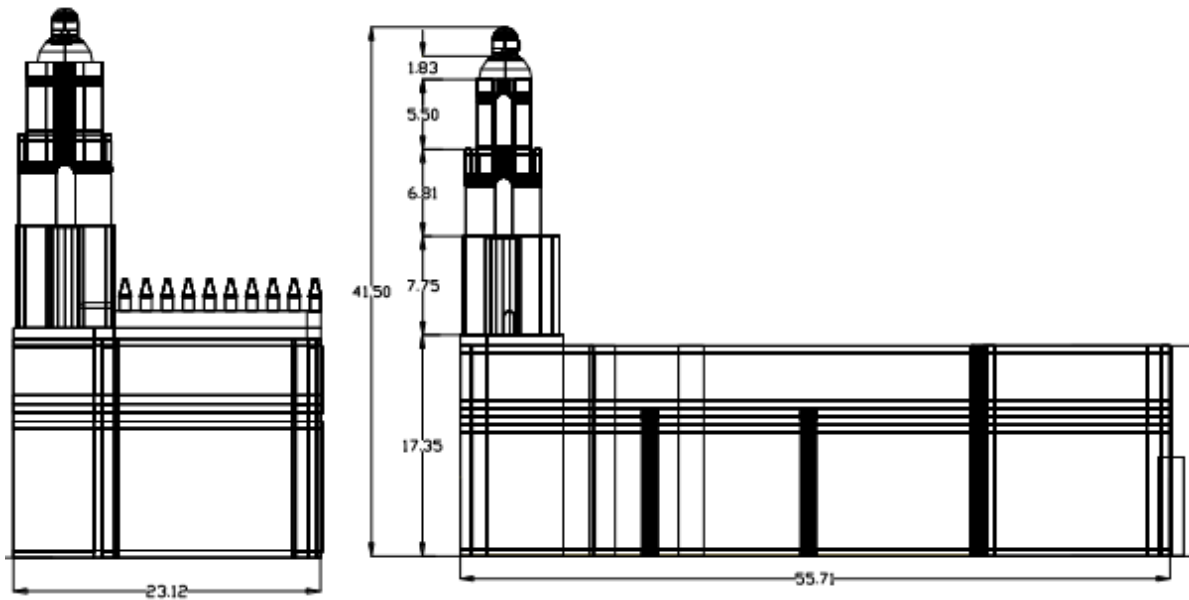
Fachada Principal y Fachada Longitudinal Sur
